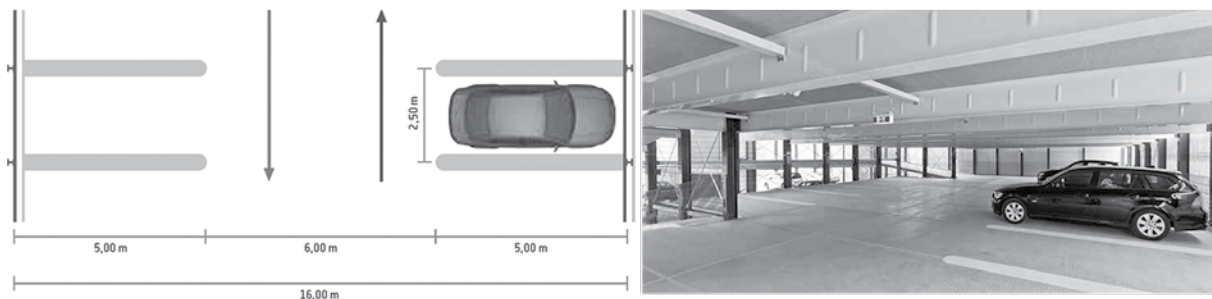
Standardmäßige Abmessungen im Parkhausbau (links) und typische Verbundbauweise mit Stahllängsträgern und Fahrbahnplatten aus Normalbeton (rechts) Quelle: www.goldbeck.de
